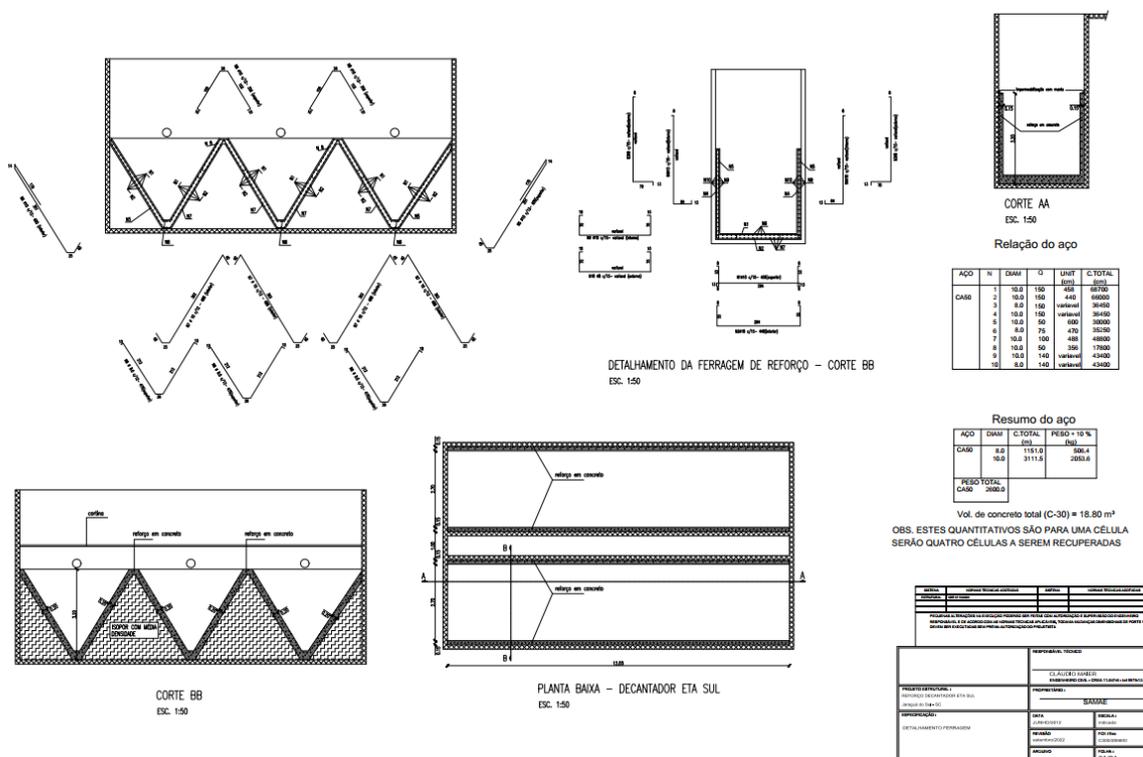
Detalhamento Reforço Estrutural dos Decantadores
